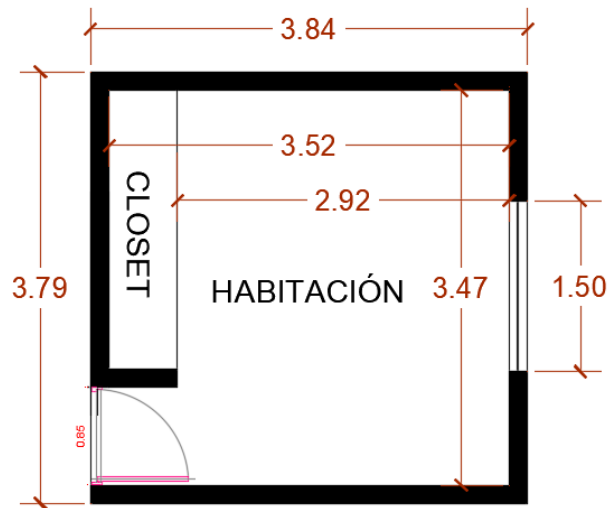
Planta arquitectónica. Elaboración propia del autor.
